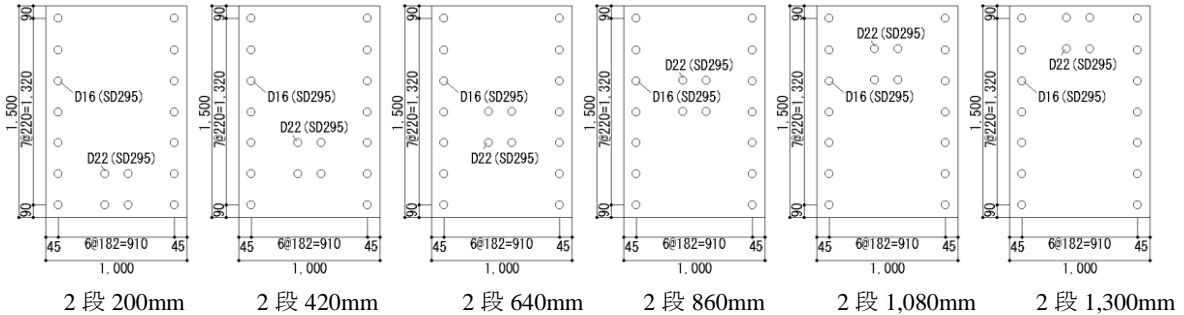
解析モデルの配筋図（2段配置：数字は下面からひび割れ補強鉄筋重心までの距離）
